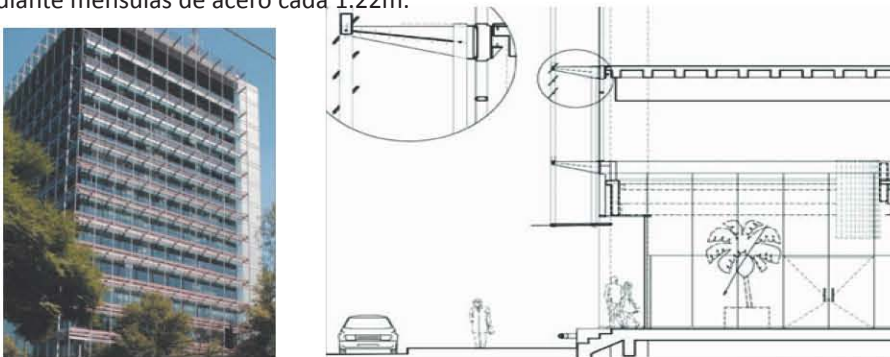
PEdificio "Gor." Fachada y detalle constructivo. Fuente: <http://www.arkinetia.com/Brevart88>.
